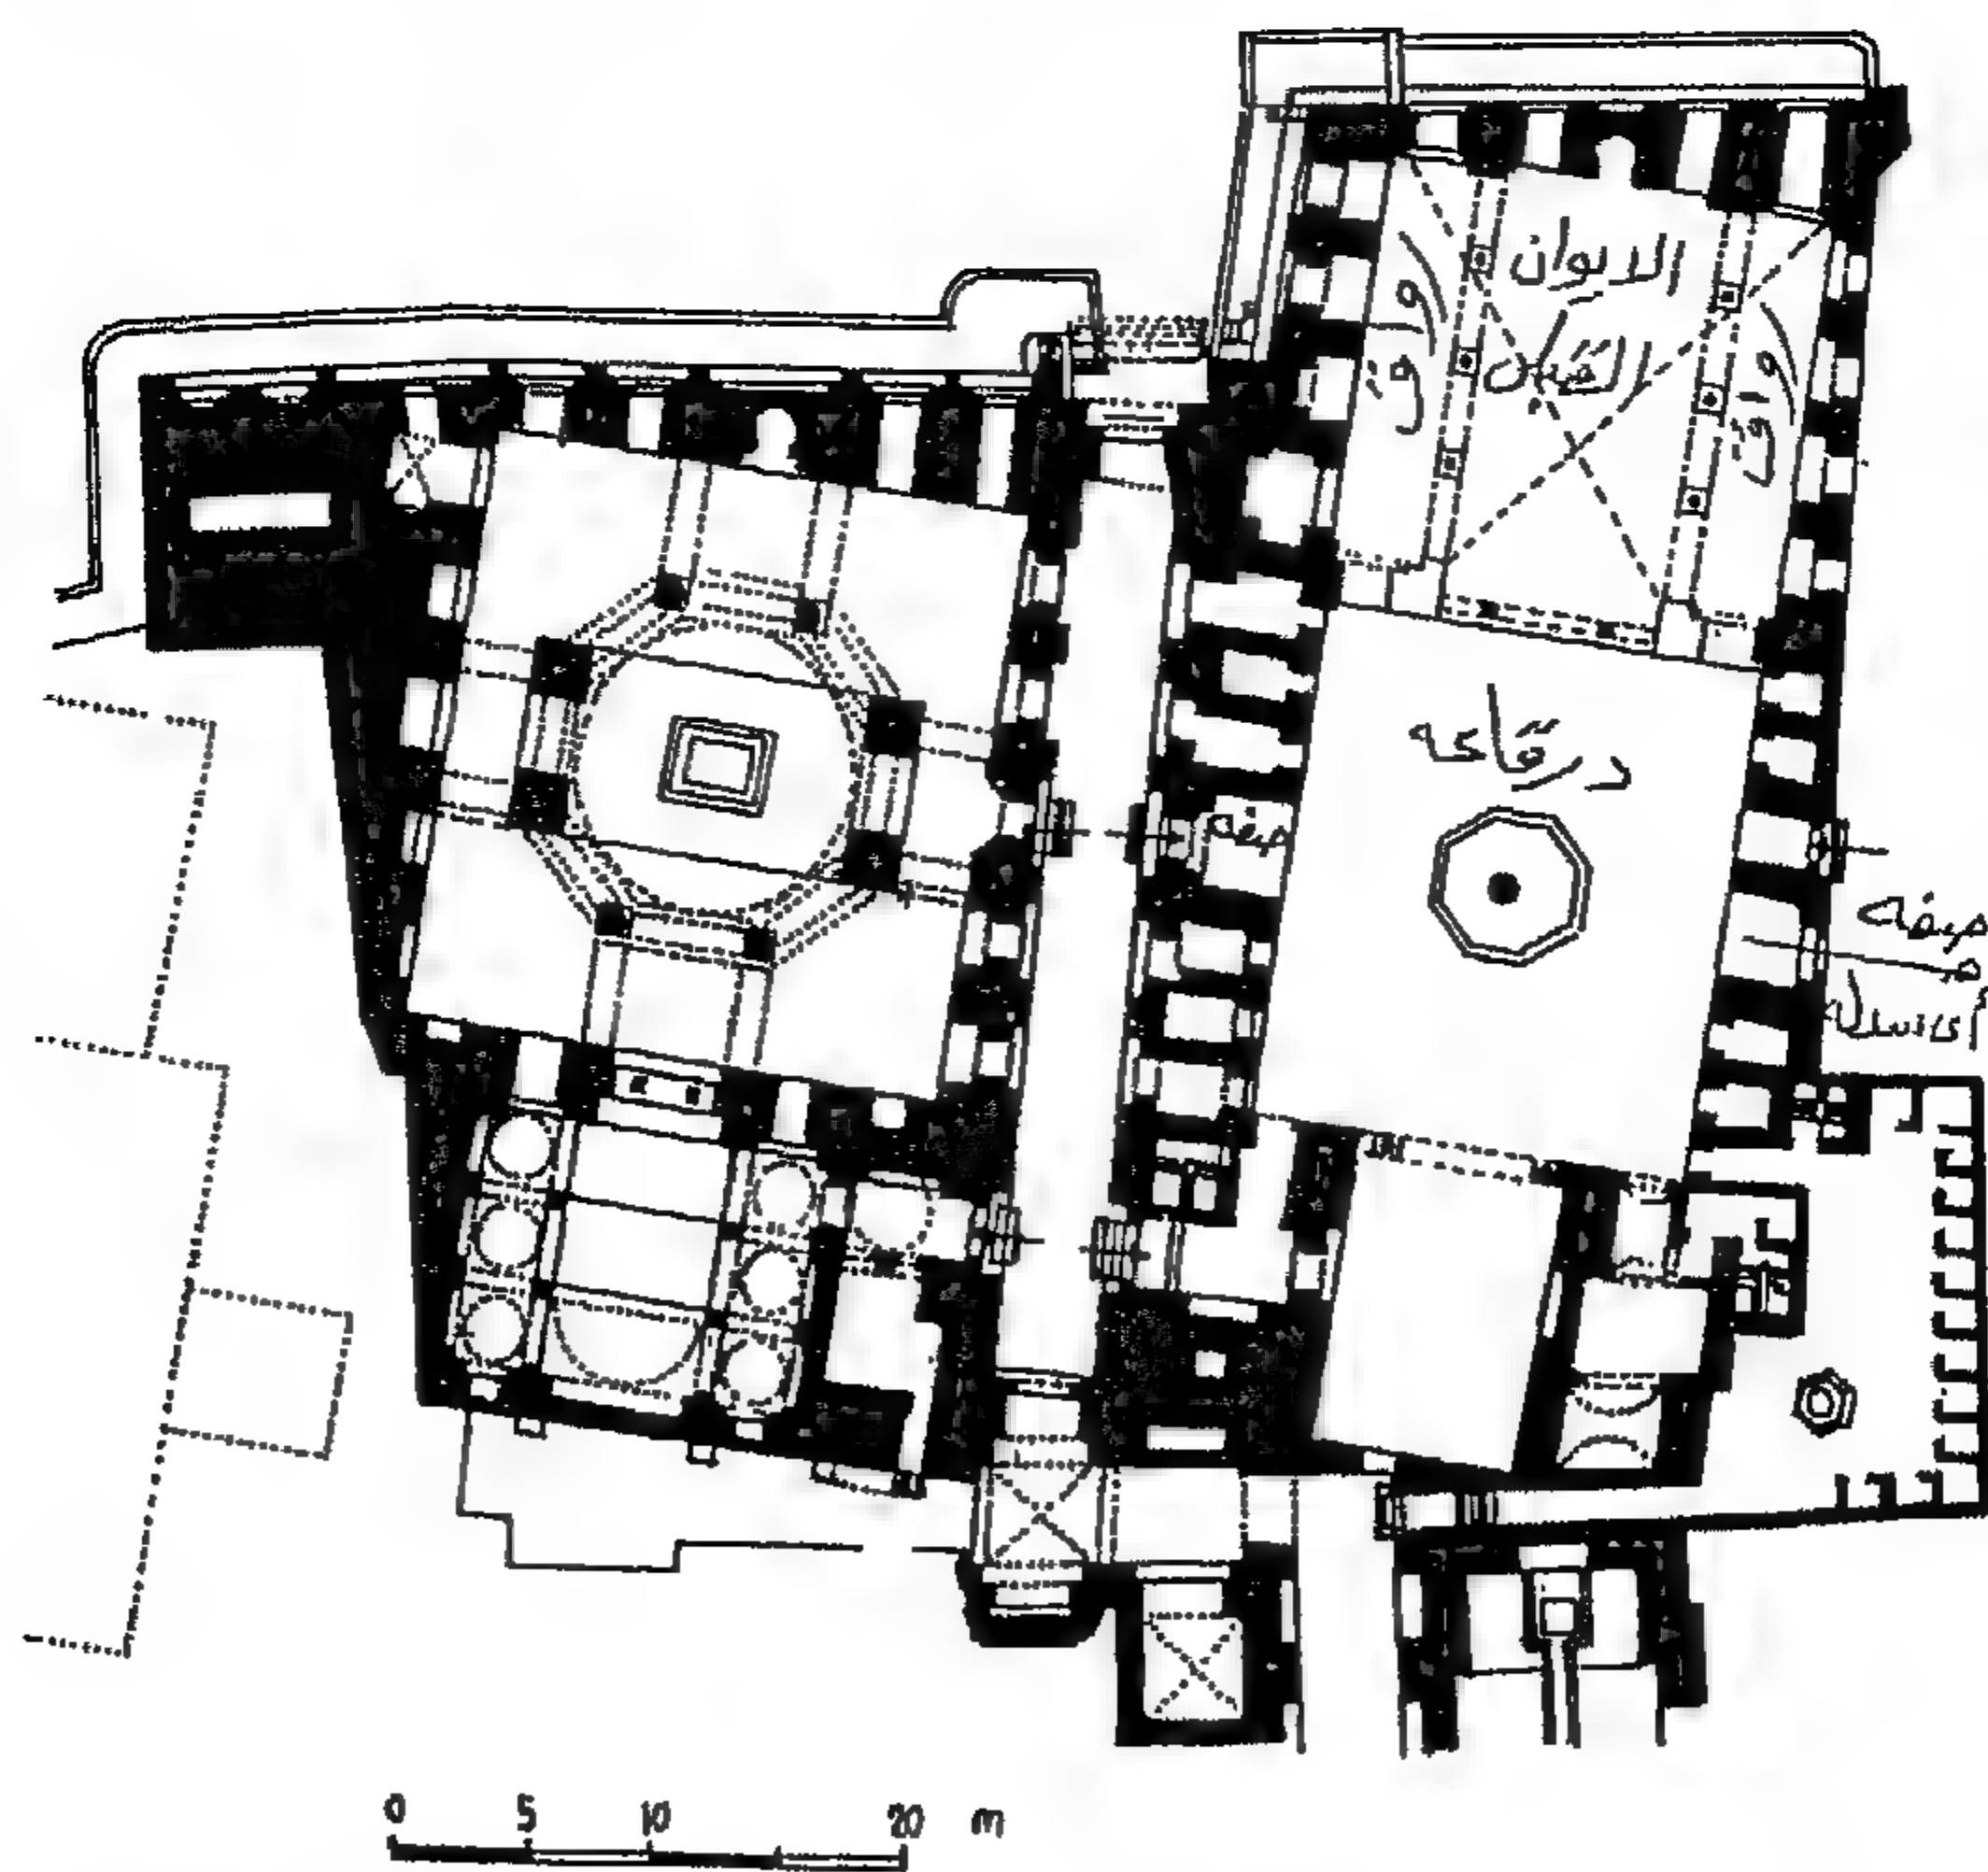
مسقط أفقي لجامع المحمودية بالقاهرة
